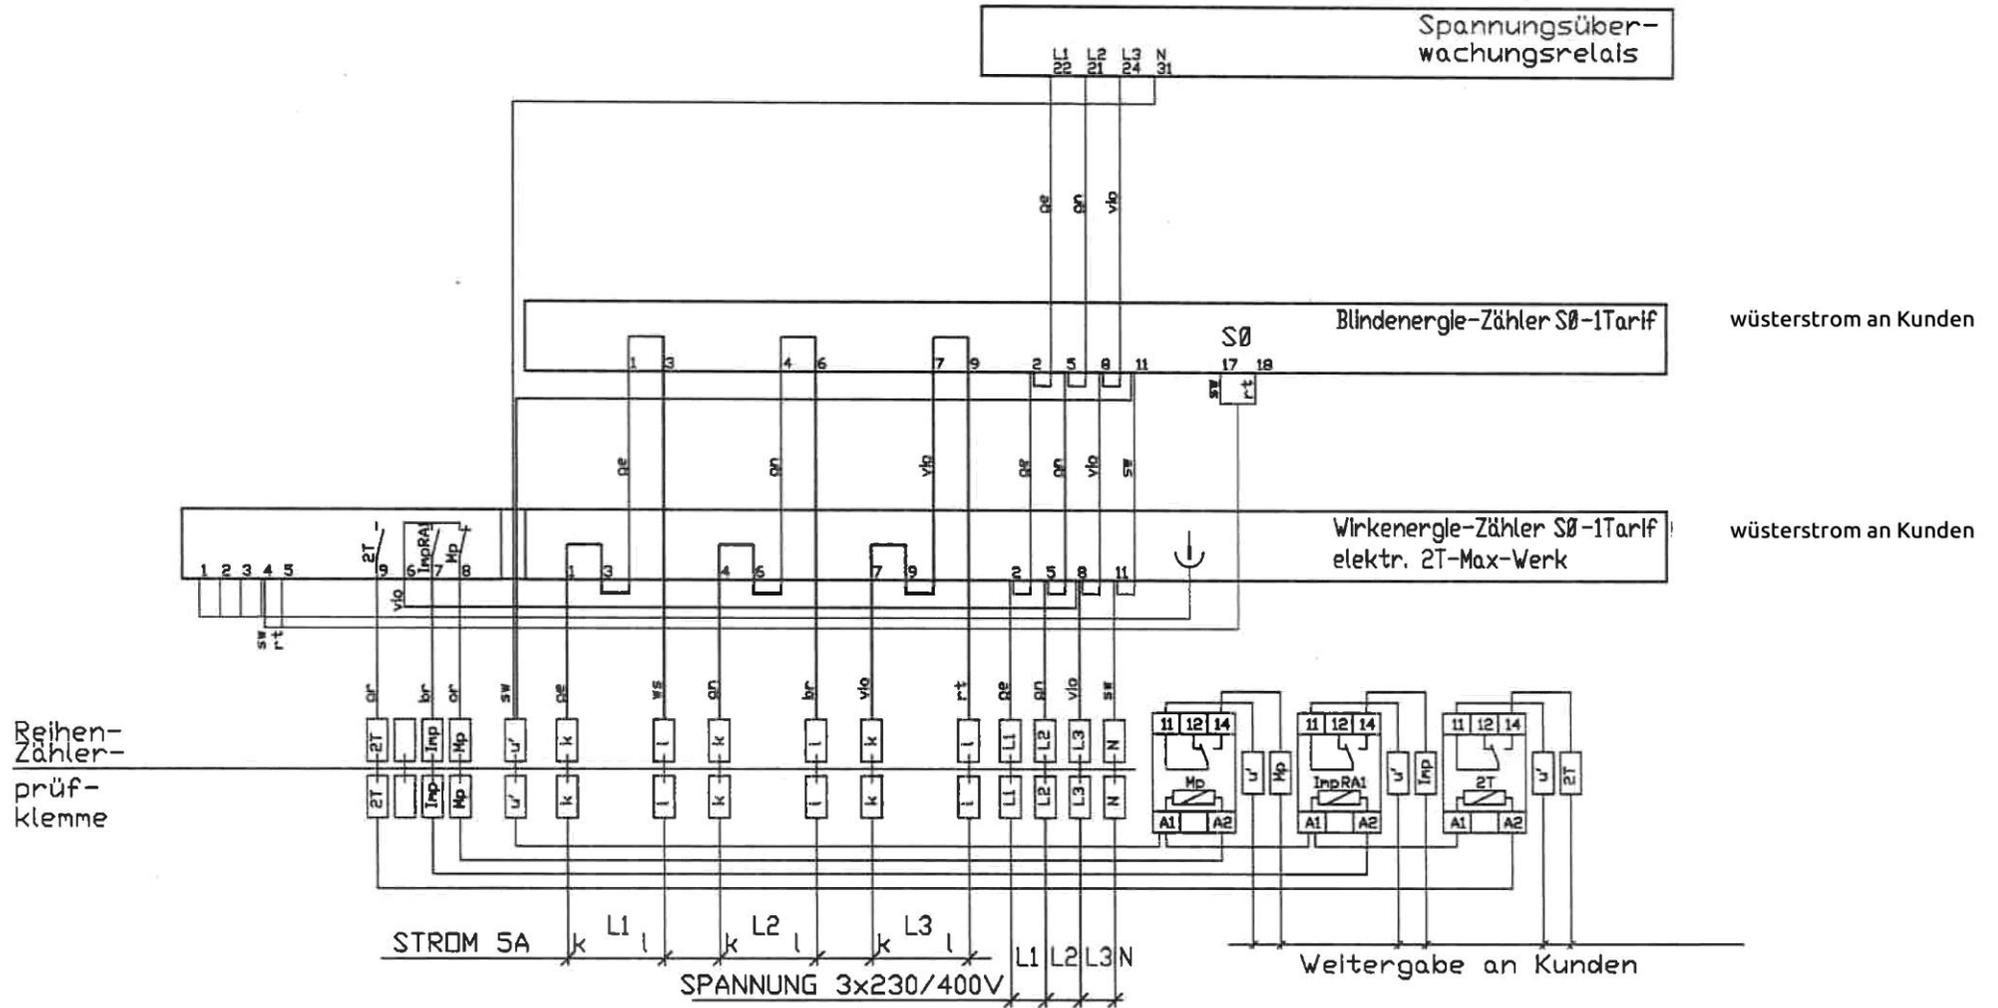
Wandlermesseinrichtung für Verrechnungszwecke – Einschubplattenverdrahtung für Zähler 3x230/400V, 5A mit elektronischem Maximumwerk
